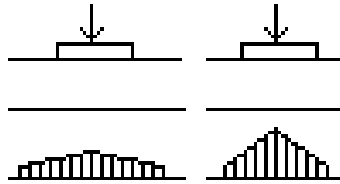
Distribución de carga característica de un Pavimento rígido y flexible.
